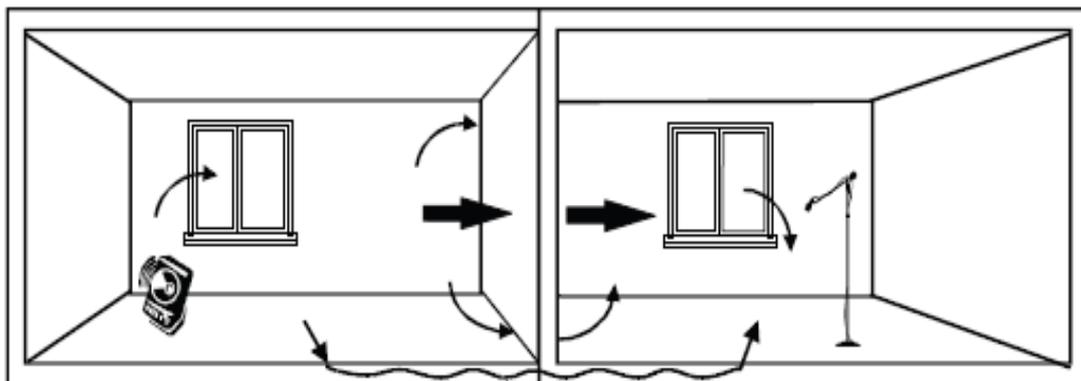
Mesurage de l'indice d'affaiblissement acoustique apparent in-situ (Vigran, 2008)
